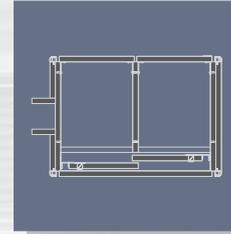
Vertikalschnitt, Schwebetürschrank, Deckenanschluß
